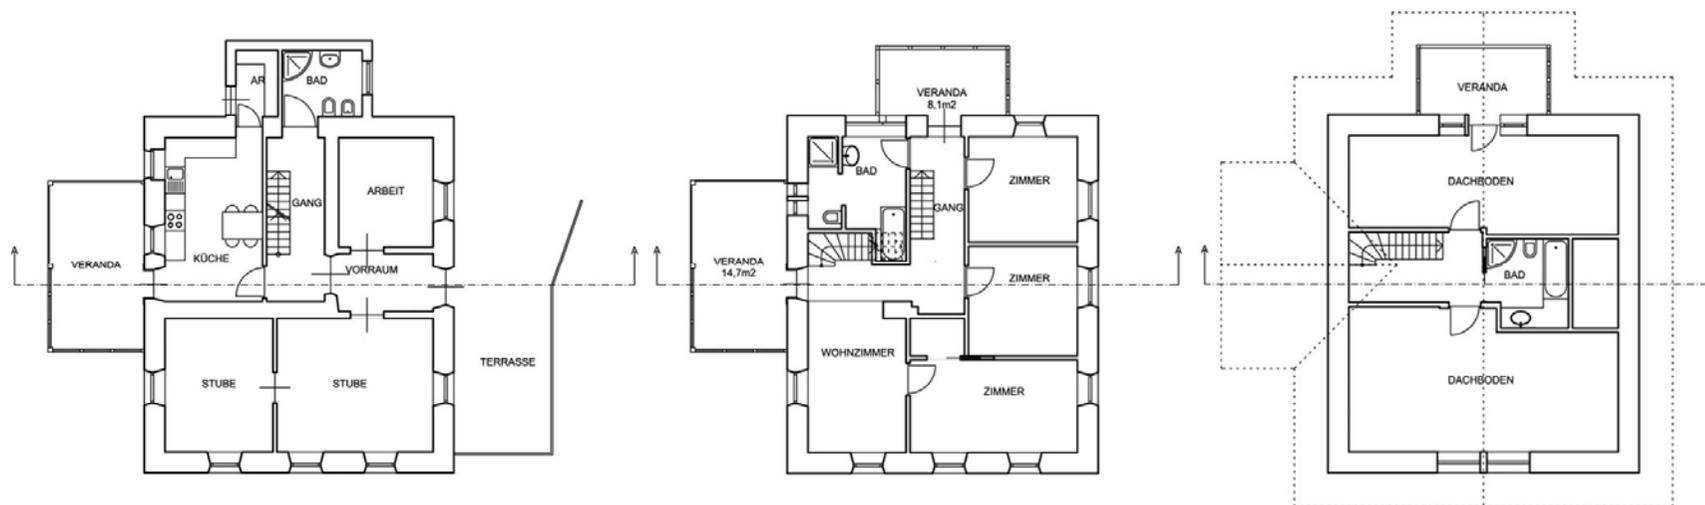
Grundrisse vom Erdgeschoss, Obergeschoss und Dachgeschoss
